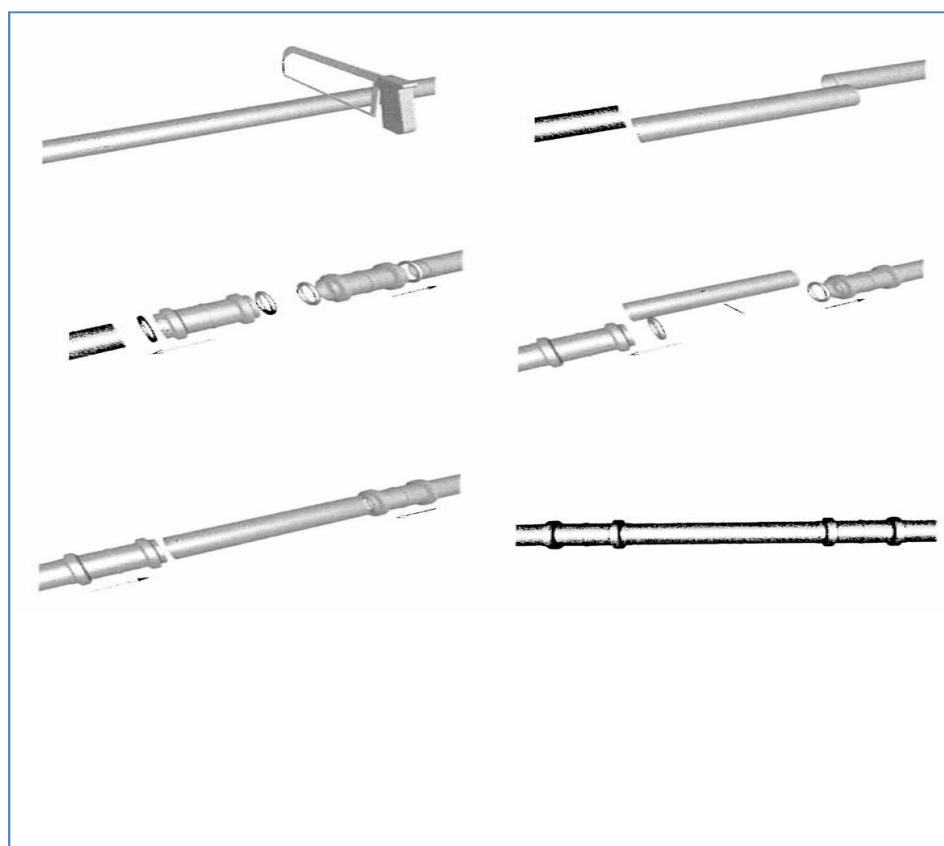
conserto de tubo PVC soldável 32 mm a 60 mm.
